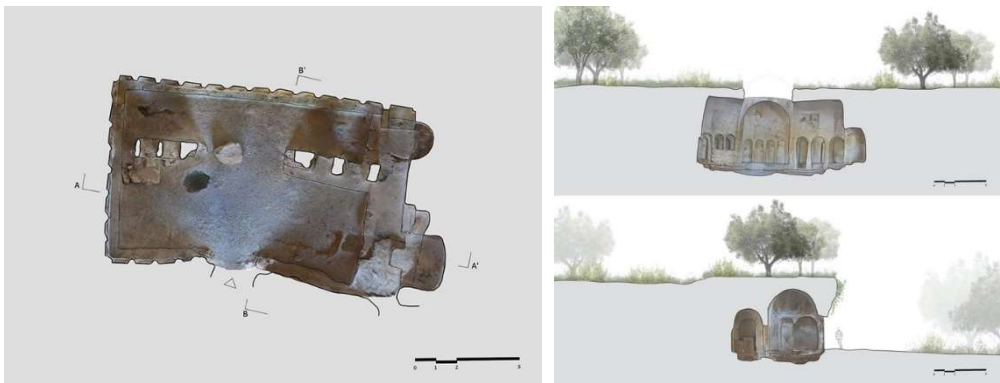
Chiesa Lama d'Antico, Fasano: planimetria (elaborazione grafica dell'autrice). Figura 3. Chiesa Lama d'Antico, Fasano: sezioni (elaborazione grafica dell'autrice).
